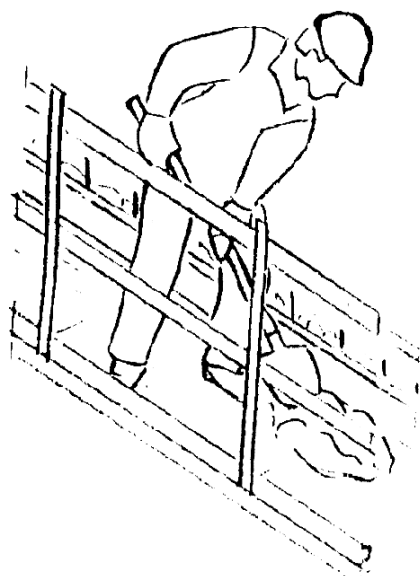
Очистка лопатами просыпавшегося бетона с деревянного настила подмостей и опалубки
